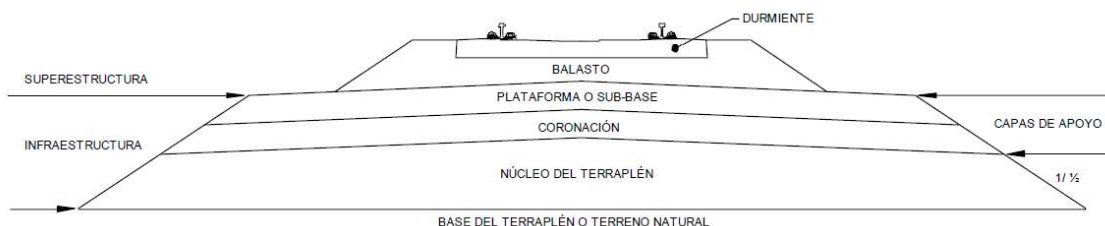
Perfil de la subestructura y superestructura ferroviaria.
